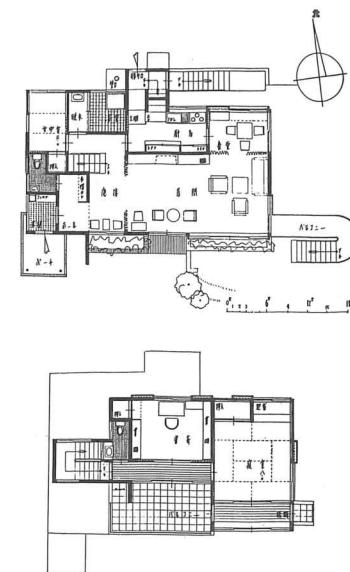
古仁所邸 1階平面図（上）、2階平面図（下）
